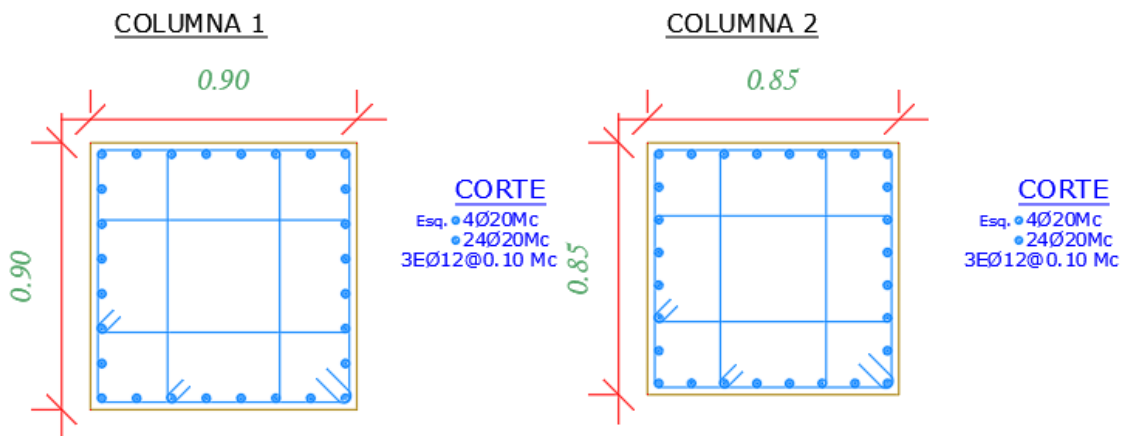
Sección transversal de la columna utilizada en un edificio de 6 pisos.
